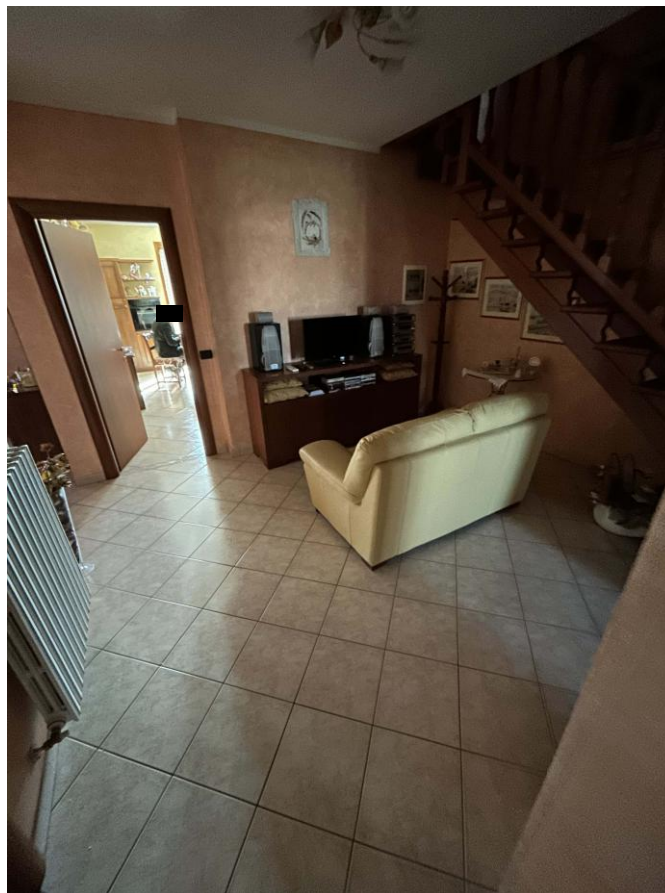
Appartamento – Piano I° – Soggiorno
